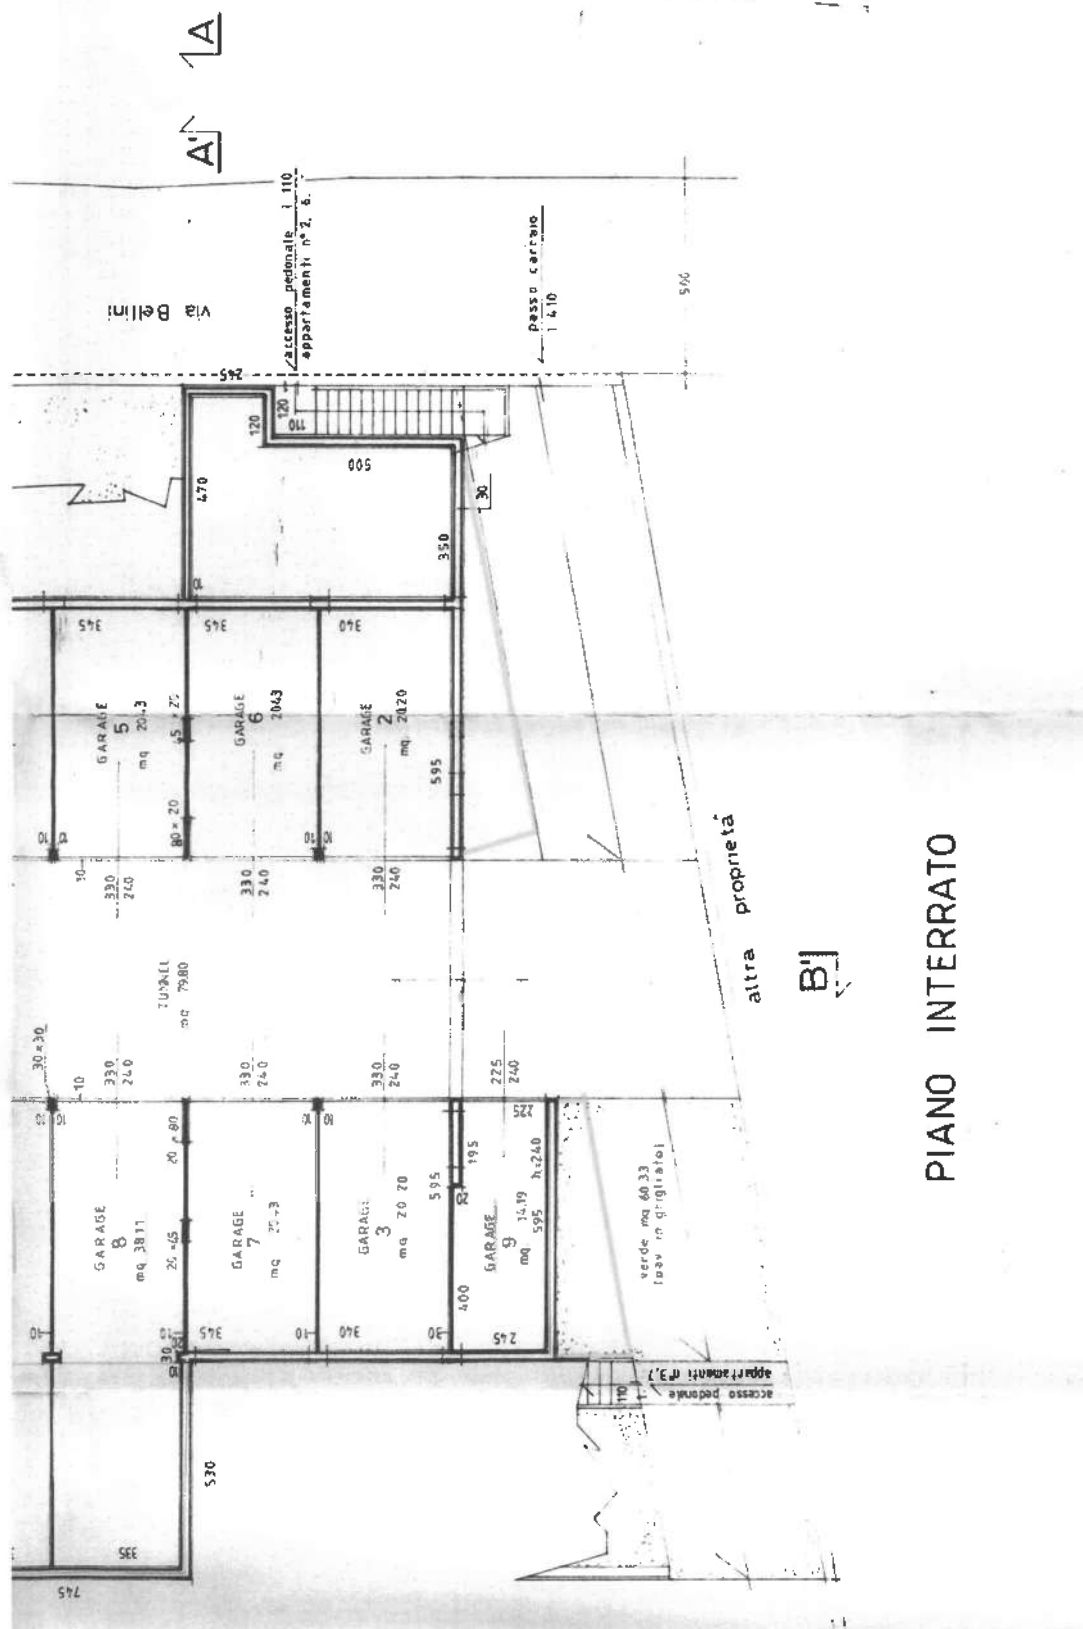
Pianta 1 Piano Interrato – Autorimessa campita in rosso
